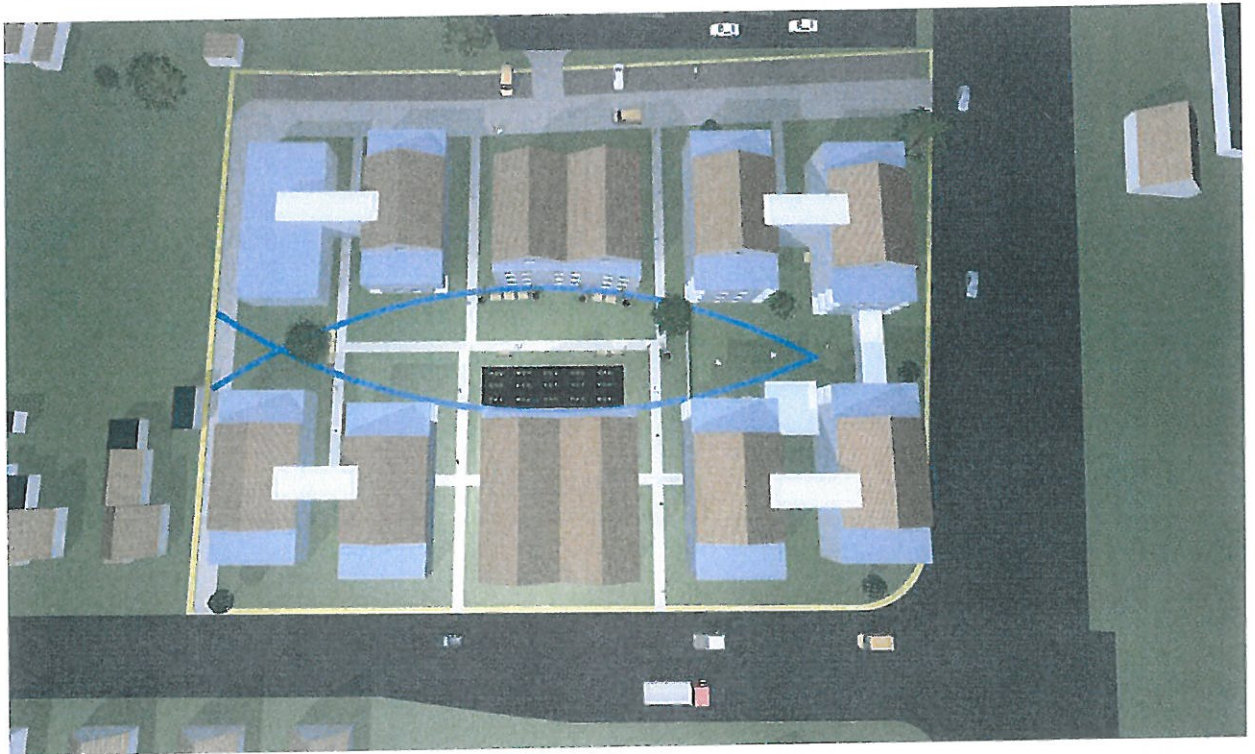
Lageplan zur Verdeutlichung der städtebaulichen Merkmale des Projekts
